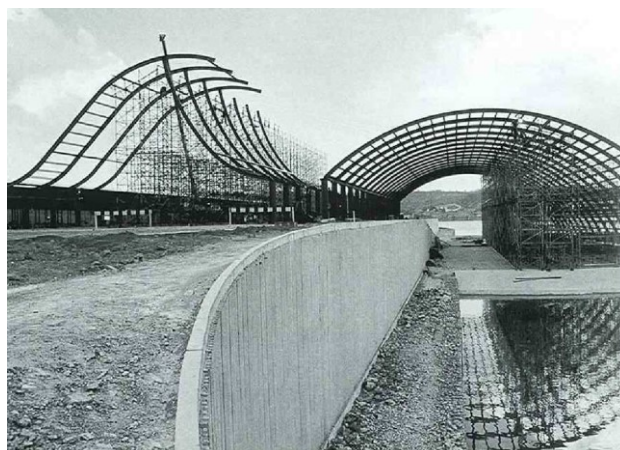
Estrutura do Ginásio dotado de vigamento duplo, apoiado em pilares metálicos de seção circular.
